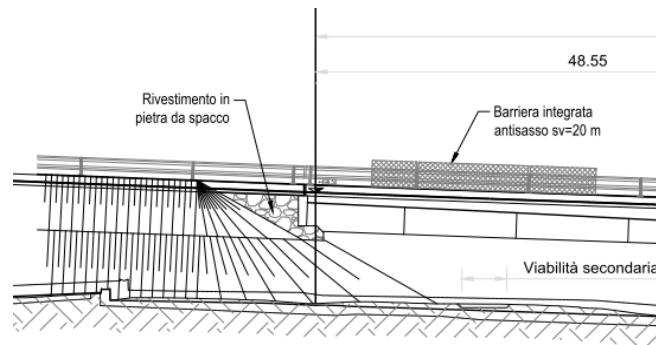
spalla1 rivestimento parti in c.a. con pietra da spacco
